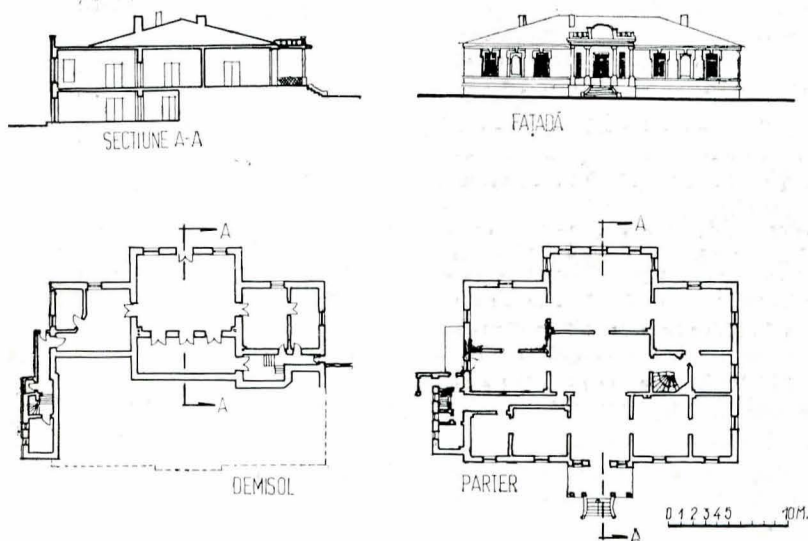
Conacul Mavros — Cantacuzino din Călinești (plan demisol, plan parter, secțiune și fațadă).
